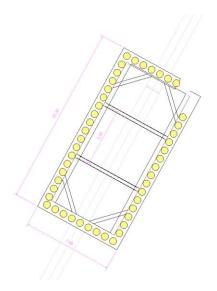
Planimetria opera provvisionale – Microtunneling A.
